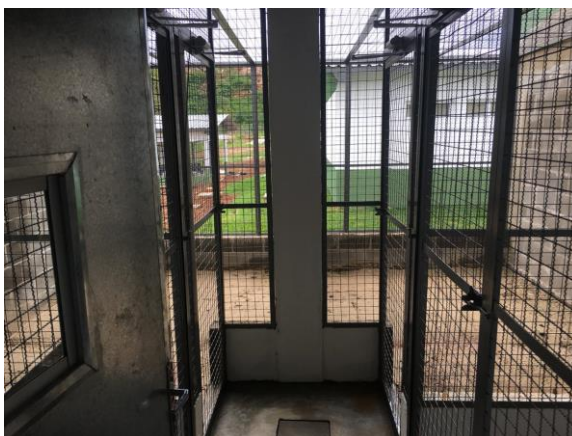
CETAS Ponta Grossa - Paraná finalizado.
